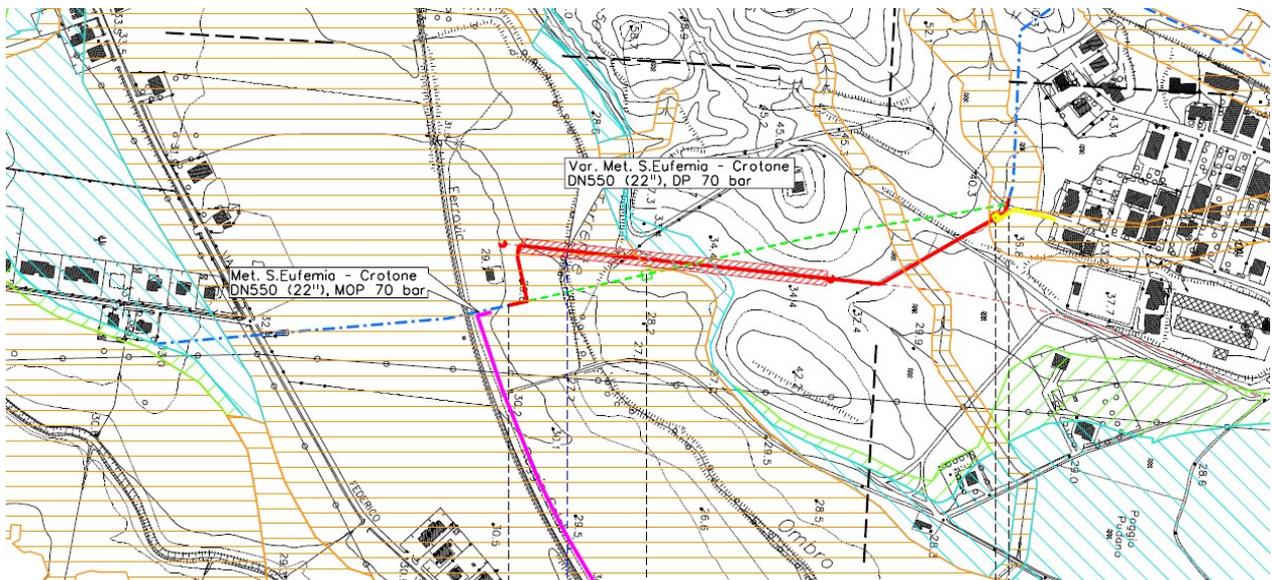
Stralcio Variante PAI approvata ma non ancora adottata (2016) – perimetrazione aree a rischio idraulico
